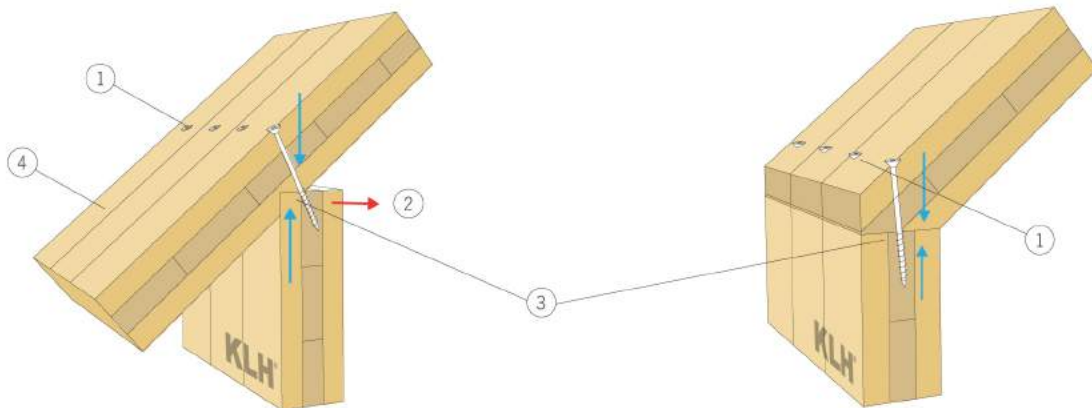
Detalhe construtivo da conexão entre painéis exteriores e piso
